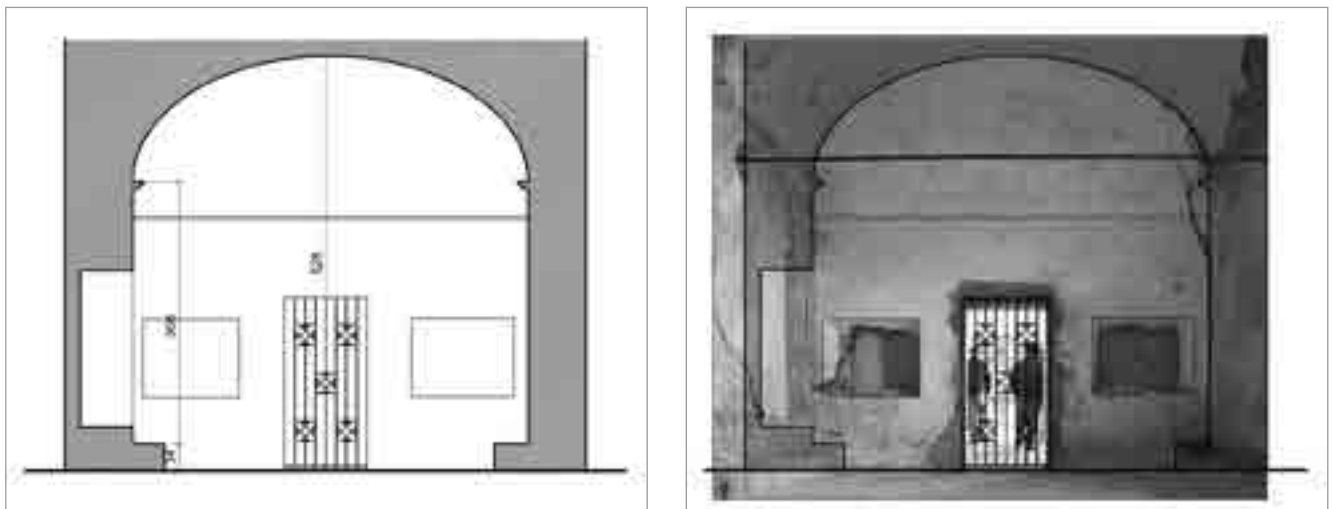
Sezione DD' quotata e con inserimento del raddrizzamento fotografico della parete di fondo.
